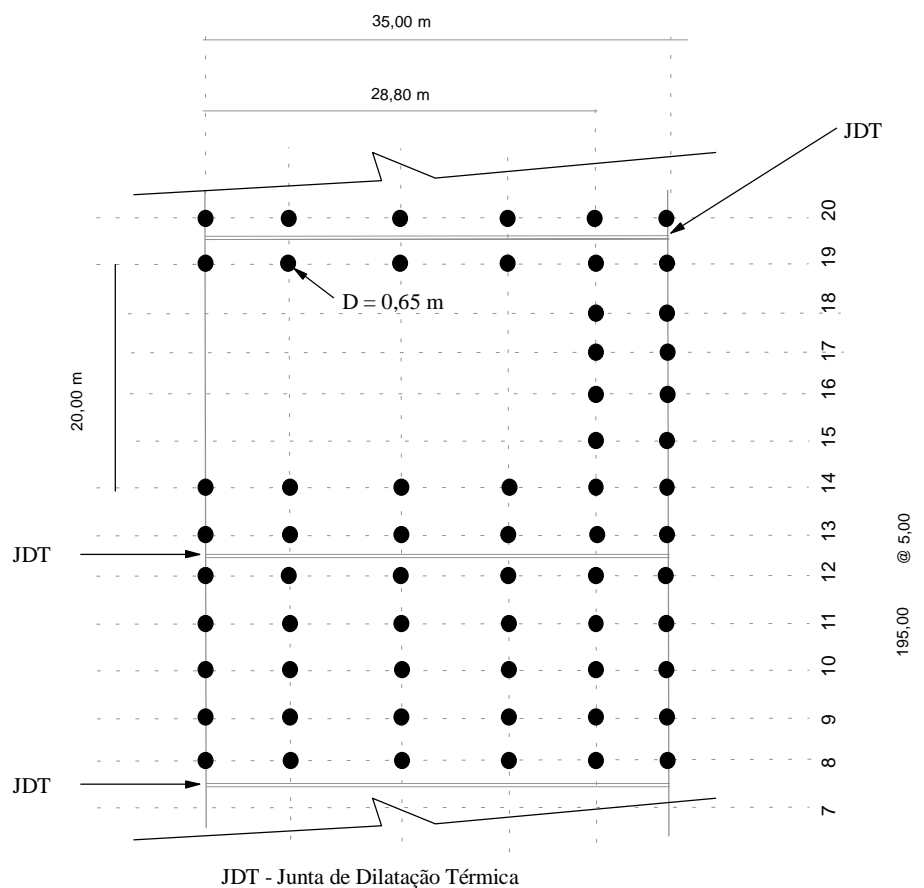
Corte horizontal no nível do 1º teto estrutural
